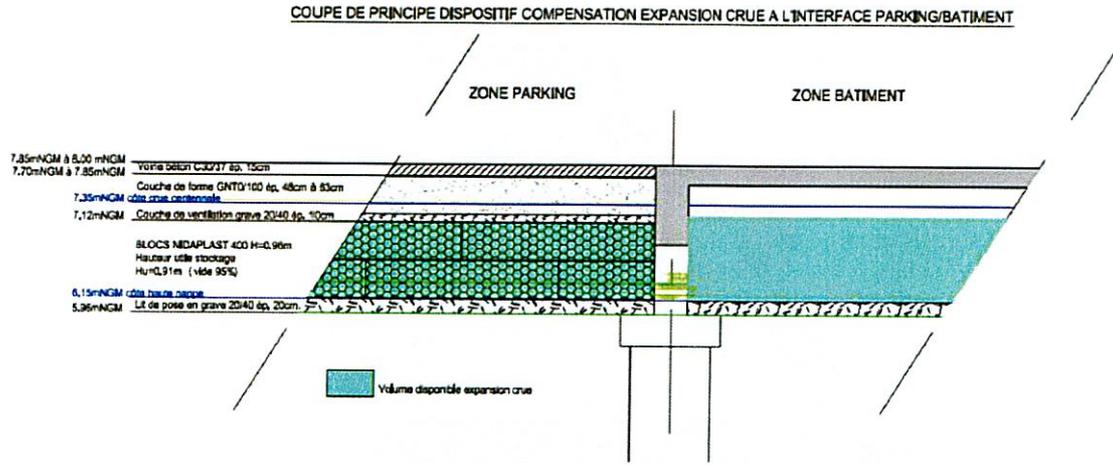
Coupe de principe sur dispositif de compensation expansion crue – interface avec les vides-sanitaires des bâtiments (Source Gestion future des Eaux Pluviales - GUEZ CARAIBES – mars 2024)
